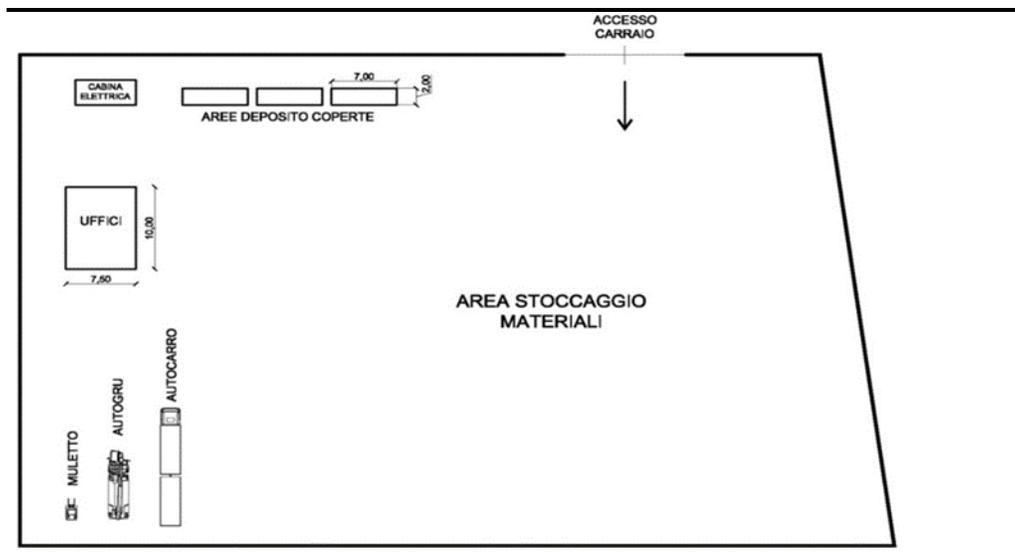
Tipologico di Planimetria dell'Area Sostegno (scavo di fondazione - getto e basi)
